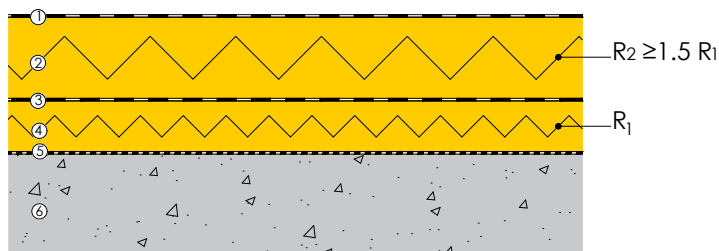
Rénovation d'une structure de toiture chaude avec plancher porteur en béton
